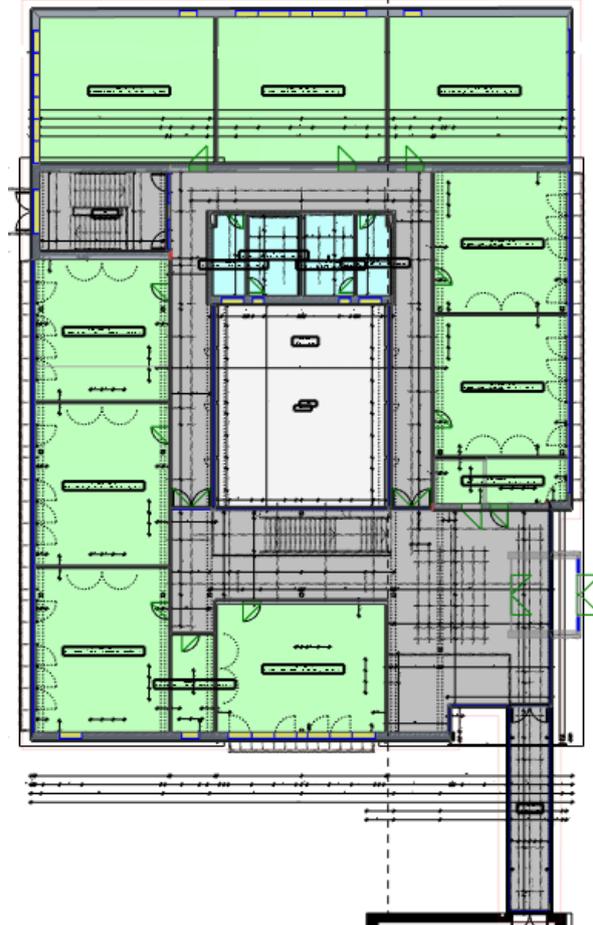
Grundriss 1.OG, zoniert
